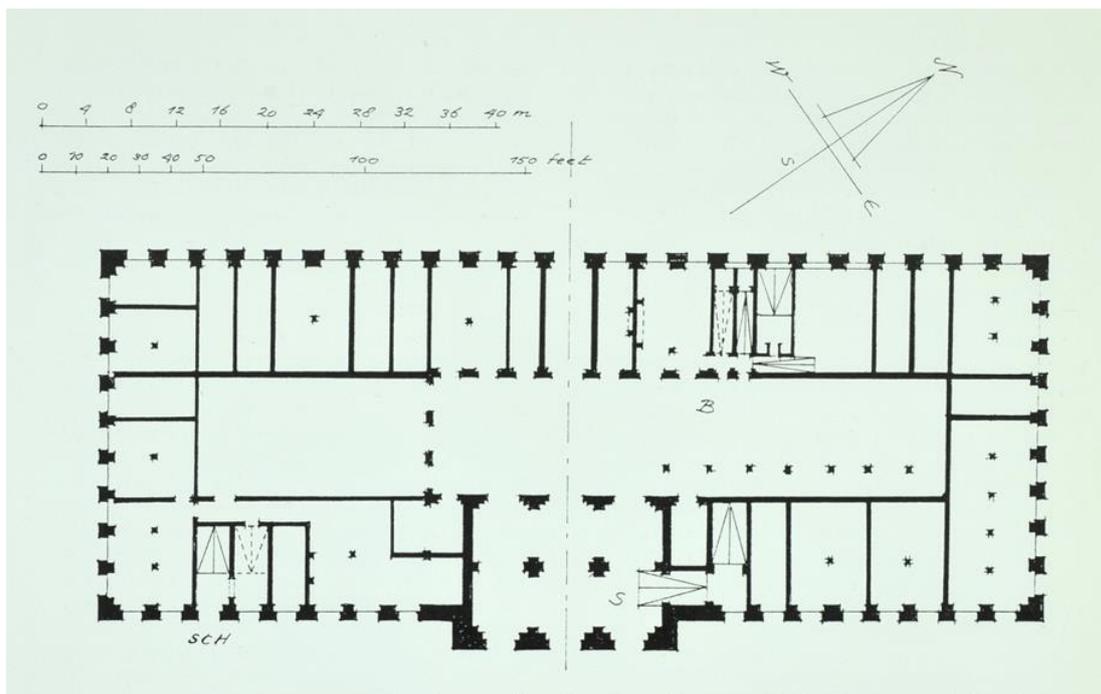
Antwerpen, Rathaus, Grundriss Erdgeschoss (S - Staircase of State; B - Entry to Burgomasters' staircase in open court; SCH - Staircase to Citizens' Hall) (aus: Kuyper 1994)
